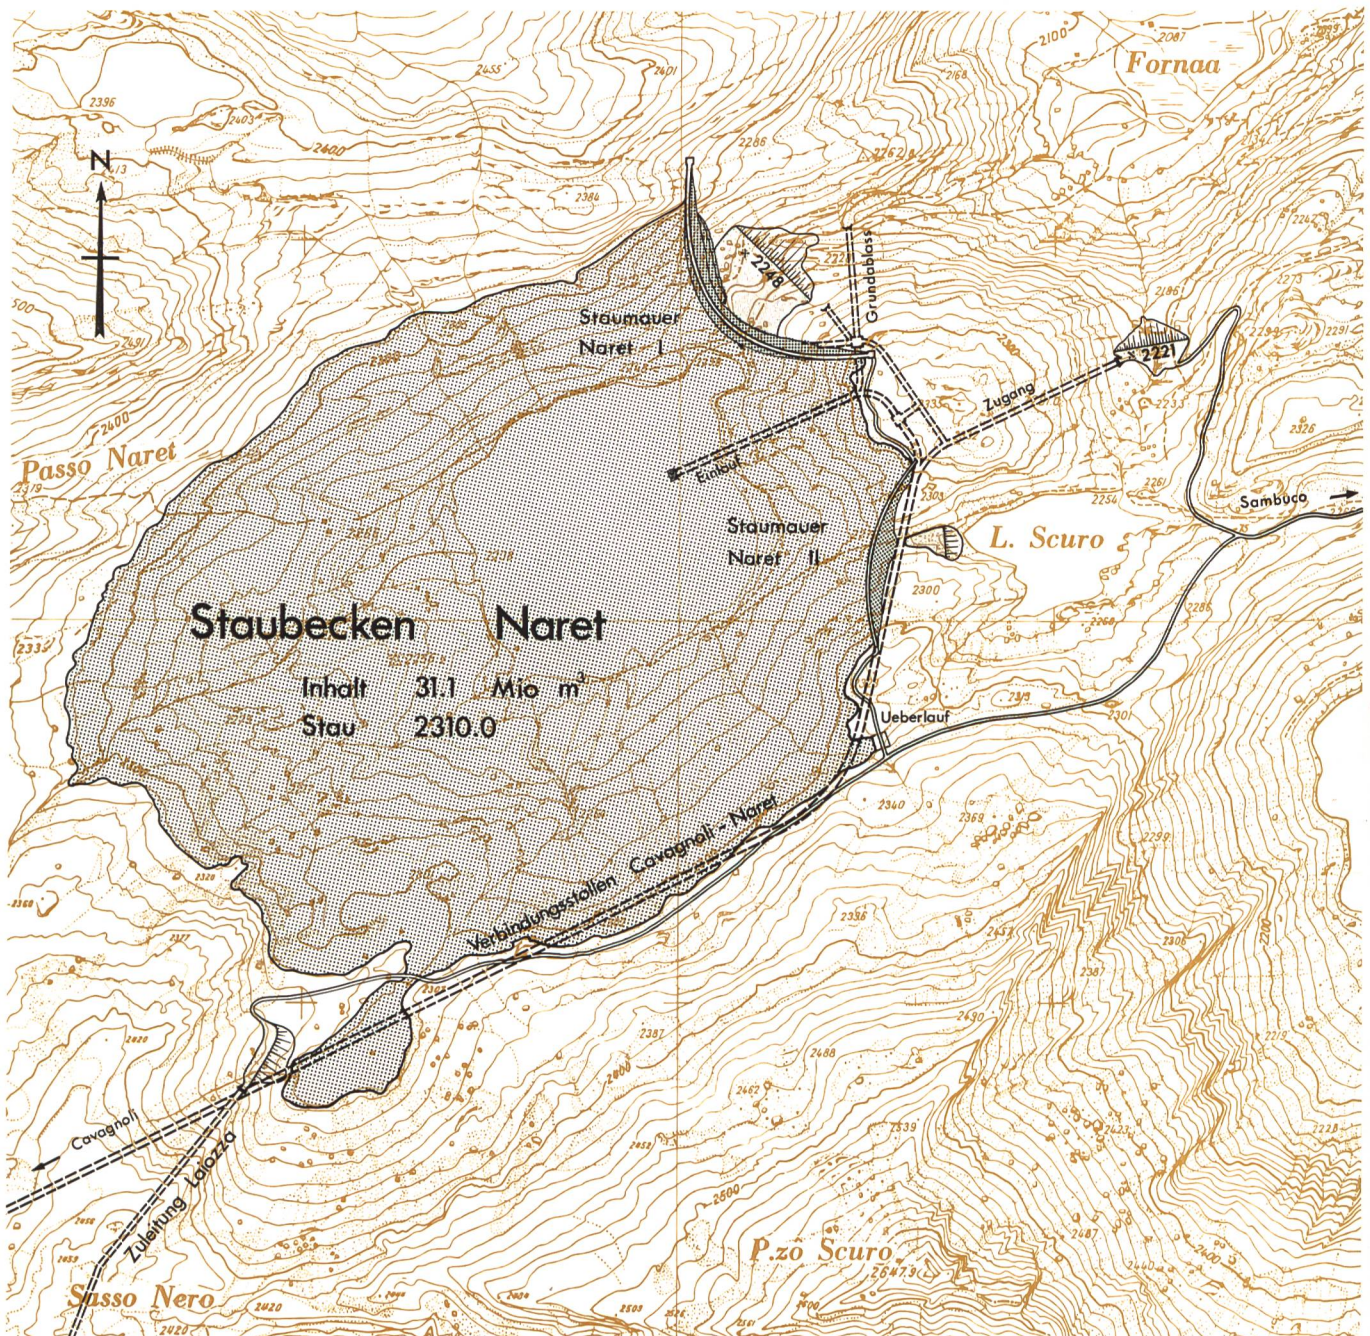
Staubecken Naret, Lageplan 1 : 10 000
